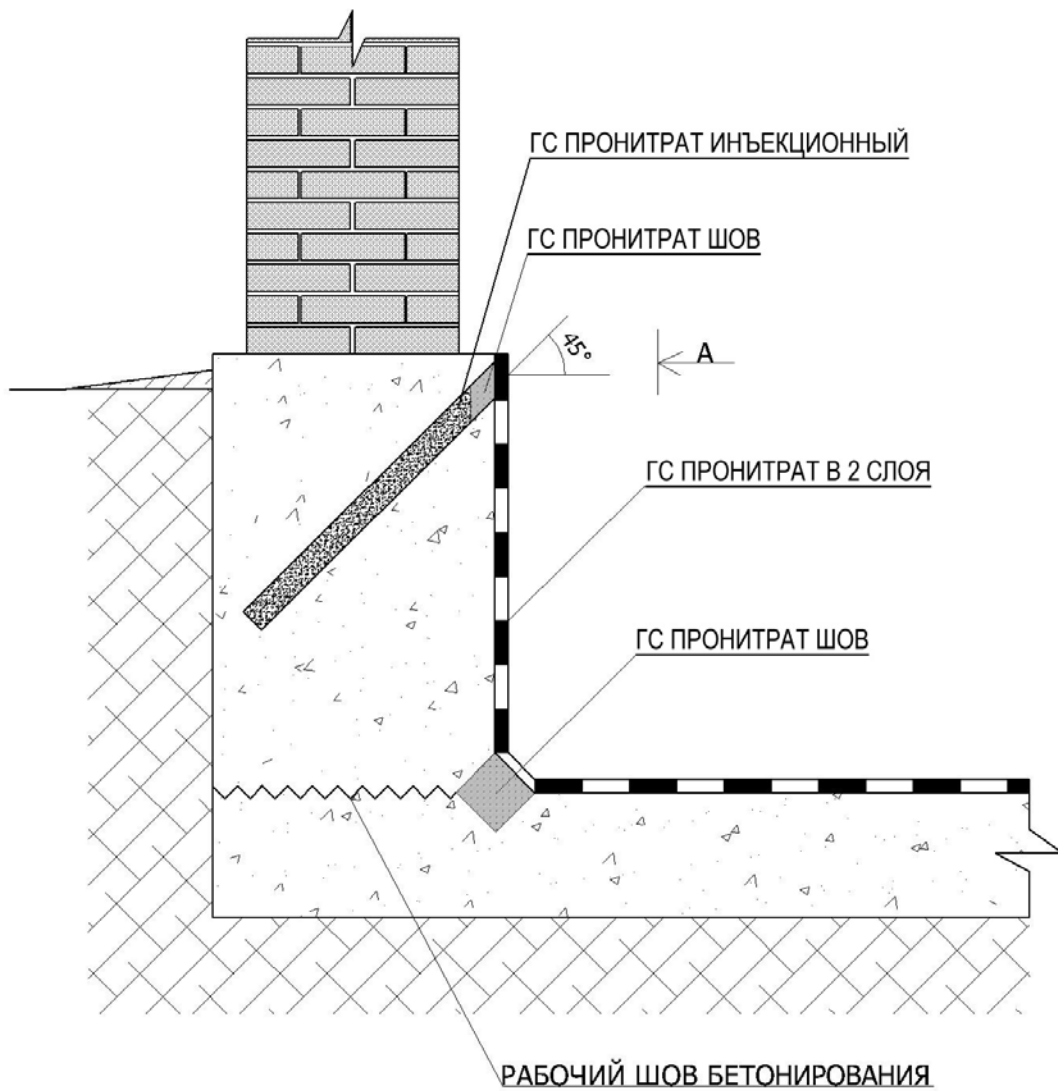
Гидроизоляция бетонного фундамента и отсечение капиллярного подсоса между бетонным фундаментом и стеной, выполненной из пористого материала, в строящейся конструкции
